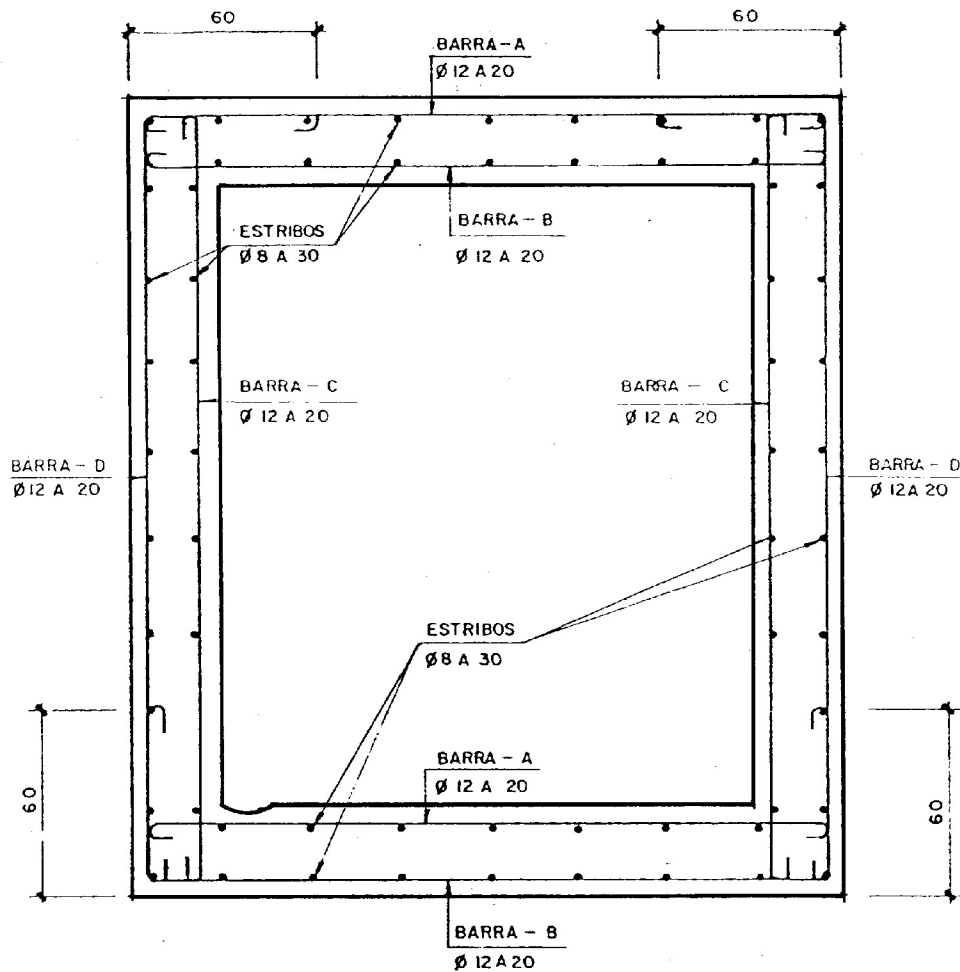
Galería de servicios, con indicación detallada de armadura y estribos de atado
